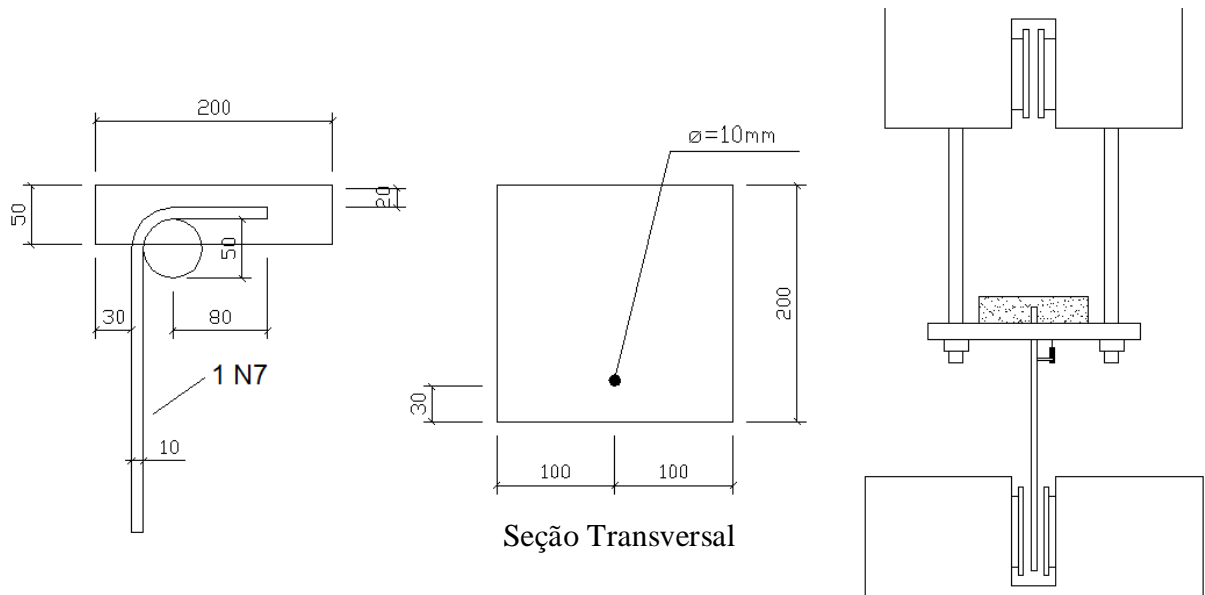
Formas do modelo de arrancamento com barras de 10 mm com gancho (dimensões em mm)
